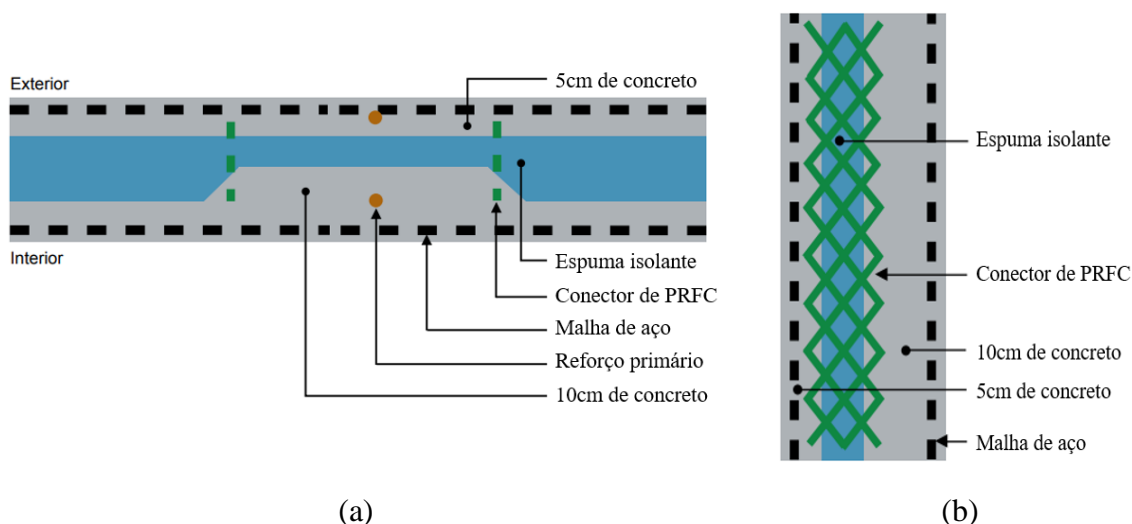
Vistas do painel sanduíche reforçado com conector de PRFC da *AltusGroup*: (a) planta; (b) corte vertical (GLEICH, 2007).
